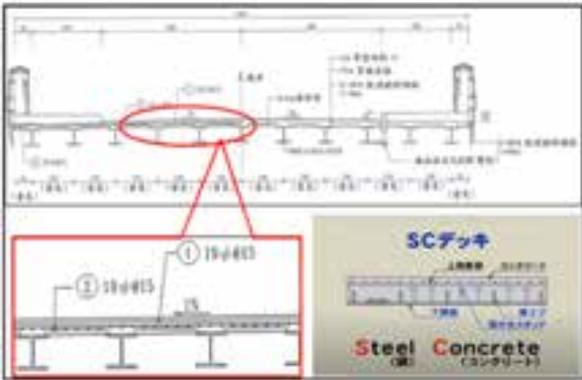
SC Deck(鋼/混凝土合成橋面板) 圖 3 SC Deck 當結構模板提升施工安全性
